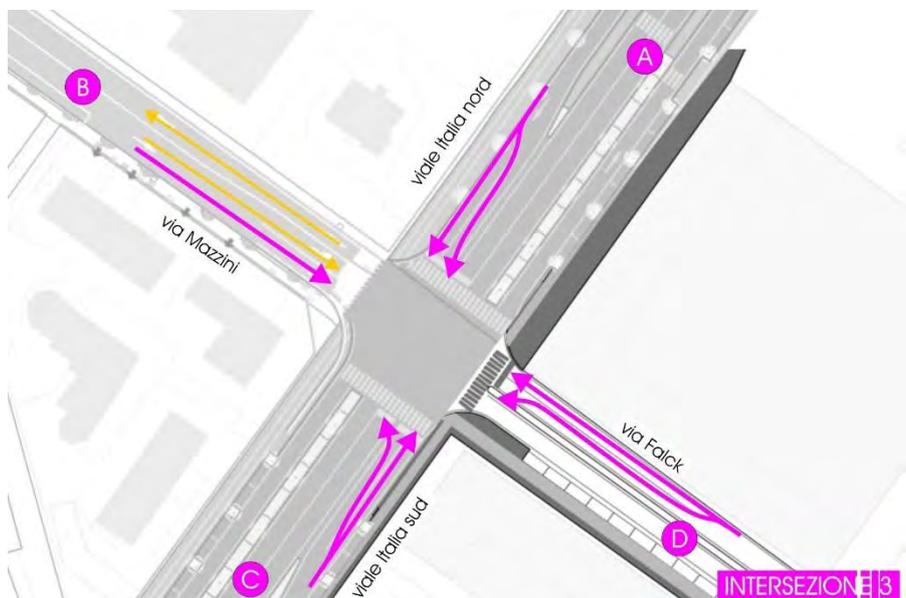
Scenario di Intervento 1 – Planimetria intersezione 3
